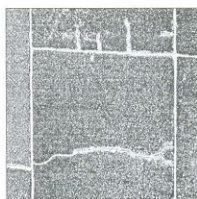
Дефекты панели до реконструкции фасада (трещина в наружном слое белого)
